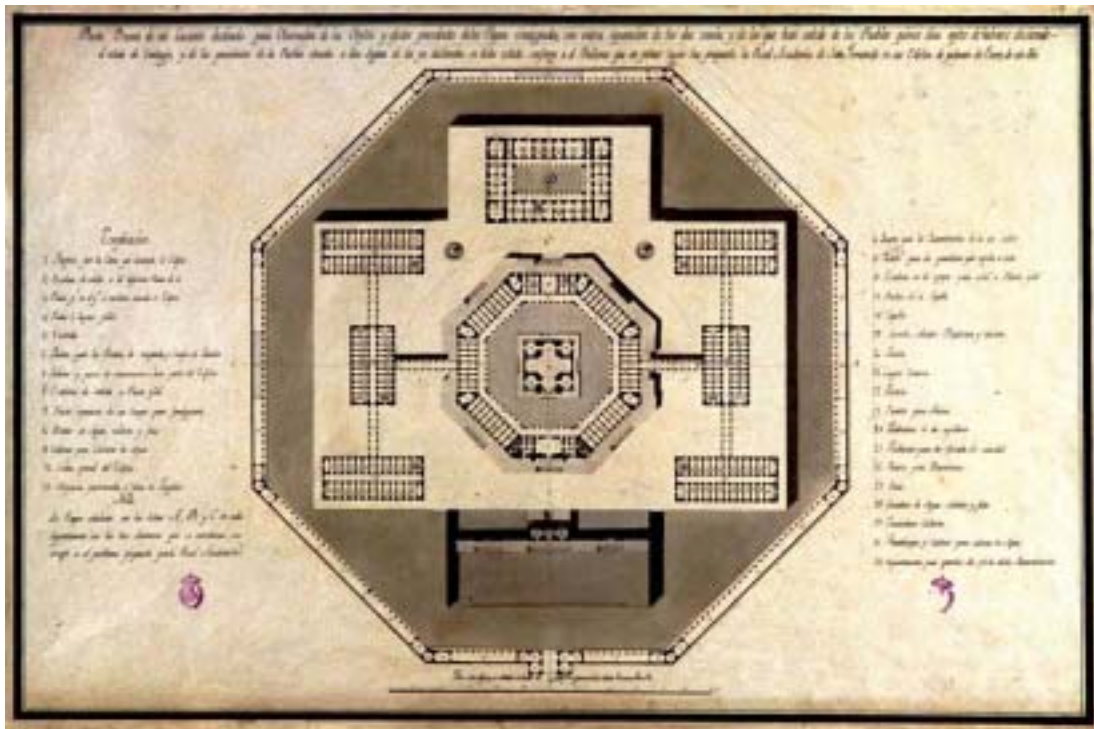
Lazareto proyectado para las afueras de Madrid, planta baja, por Pedro Nolasco Ventura, 1800-1802 (RABASF, Museo, Dibujos Arquitectónicos, A-2624)
